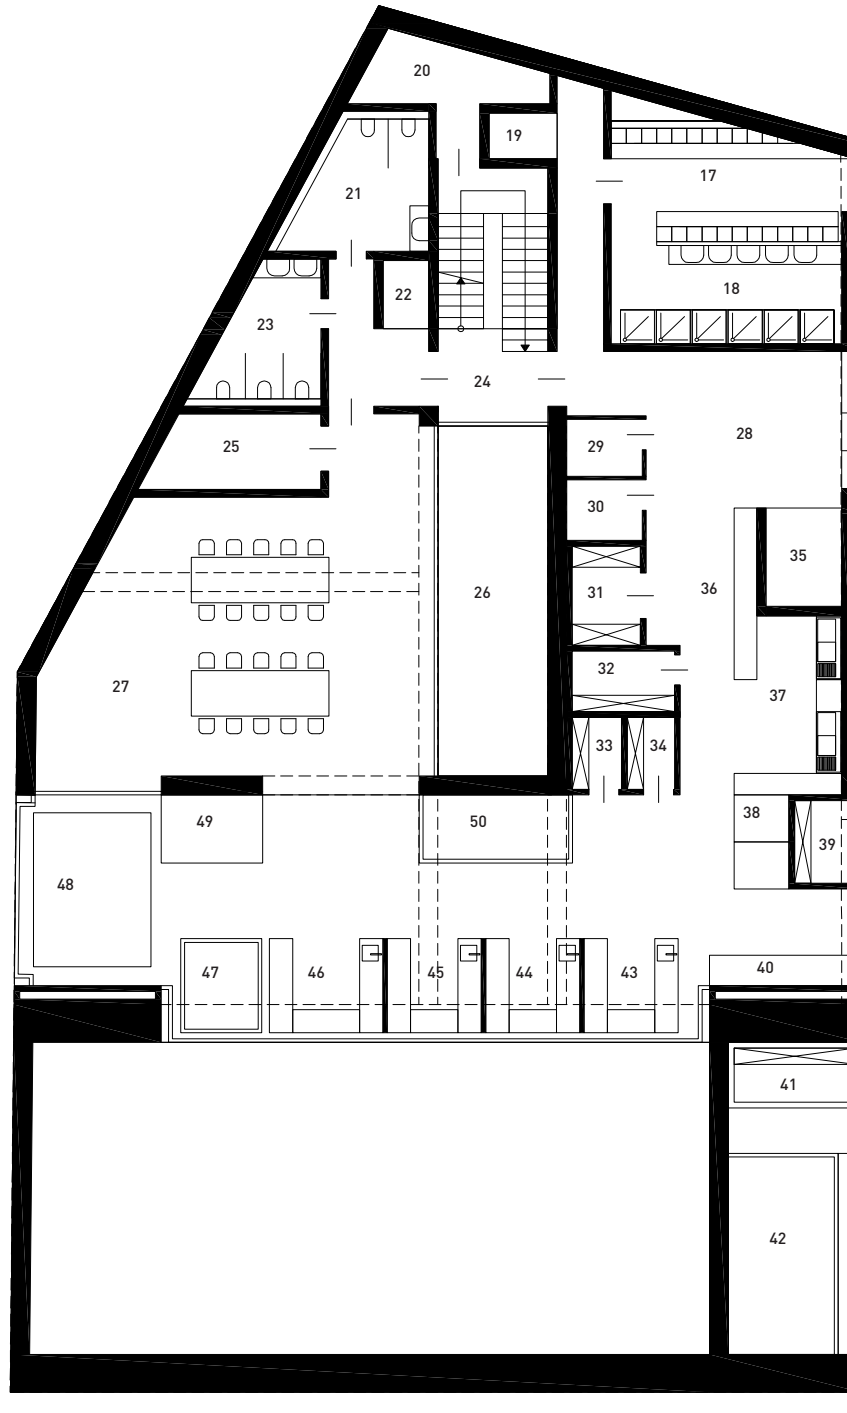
Grundriss Restaurant, Servbereich, Lagerbereich M1:200
